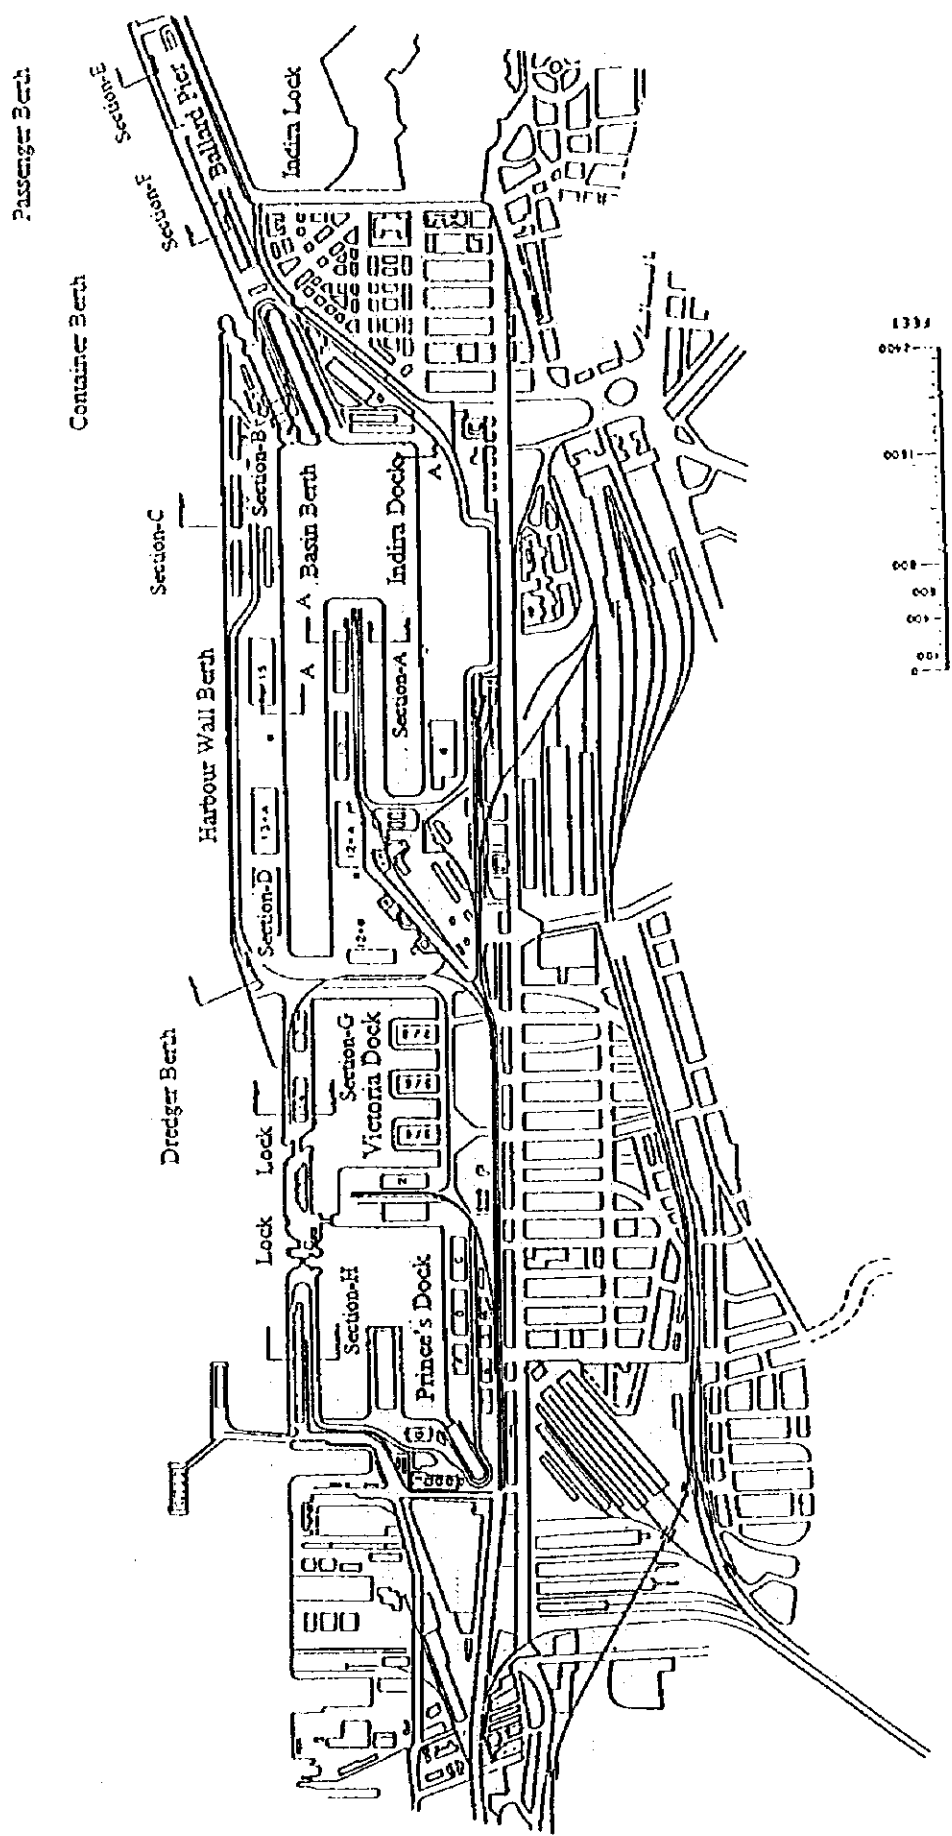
ムンバイ港の中央地区港湾施設配置図
